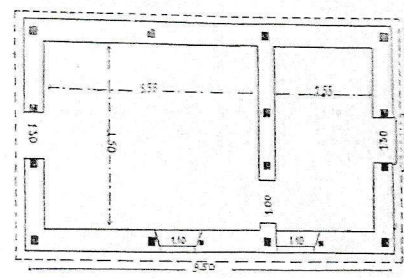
ª — CASTROLIBERO. Pianta di casa baroccata.
